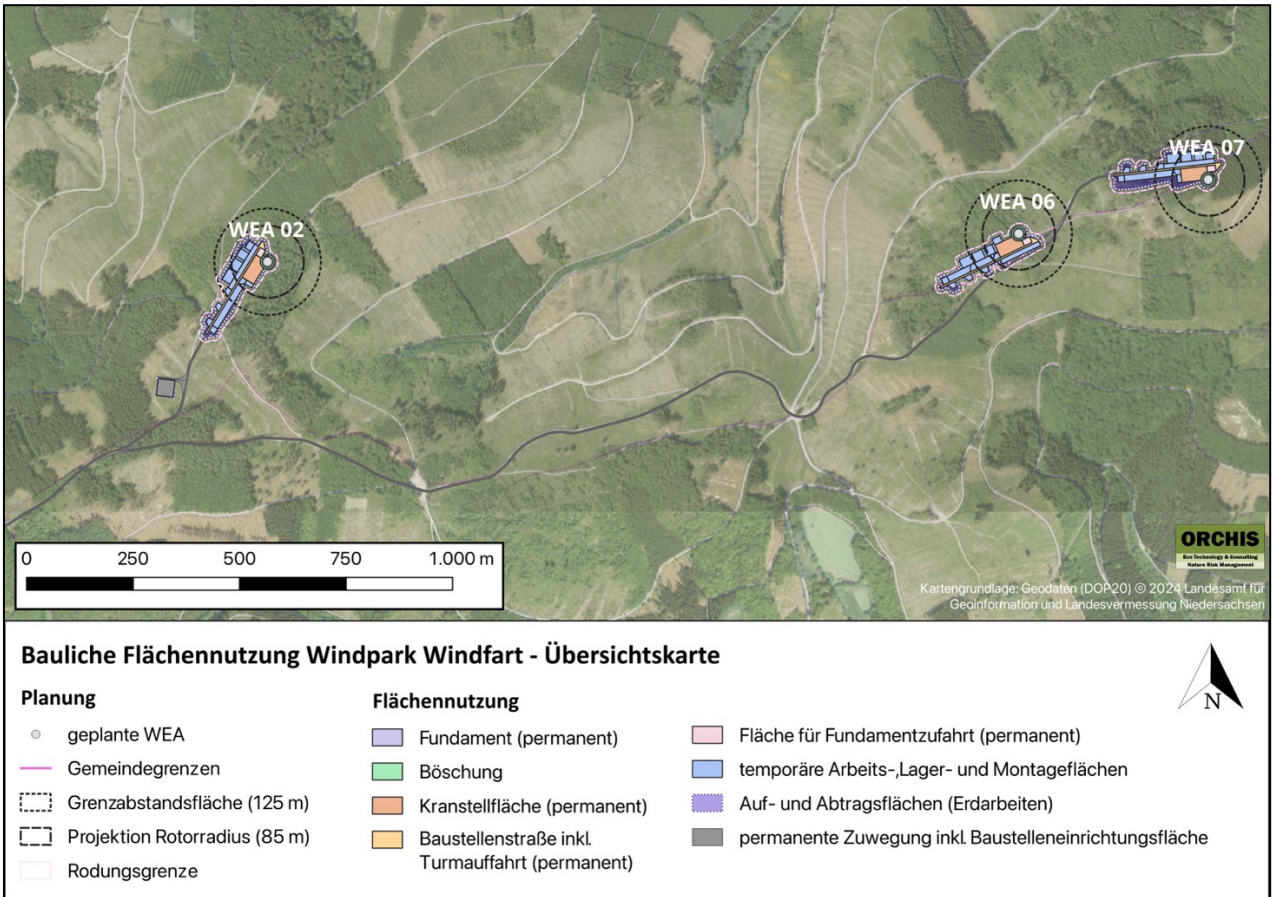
Lageplan der Flächennutzung für die Bauflächen der drei geplanten WEA (eine A3-Darstellung befindet sich im Anhang)
